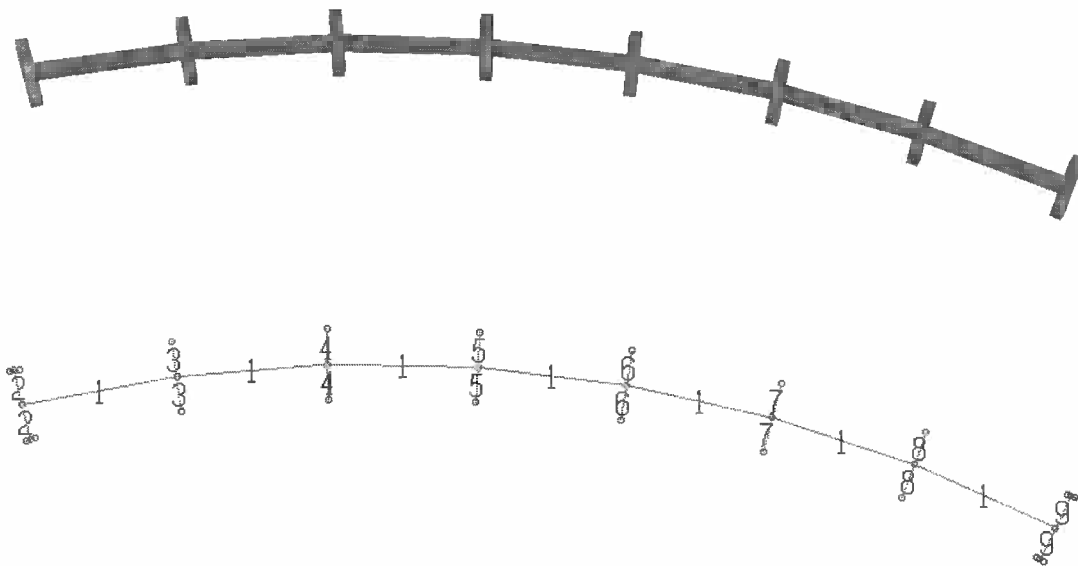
Verifiche alla fessurazione delle travi di collegamento in fondazione, indicazione degli elementi.
